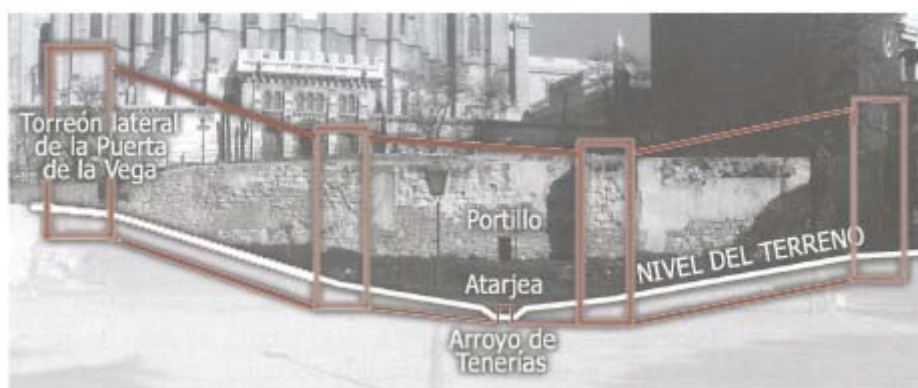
Reconstrucción aproximada del alzado original de los lienzos de la Muralla Islámica.
